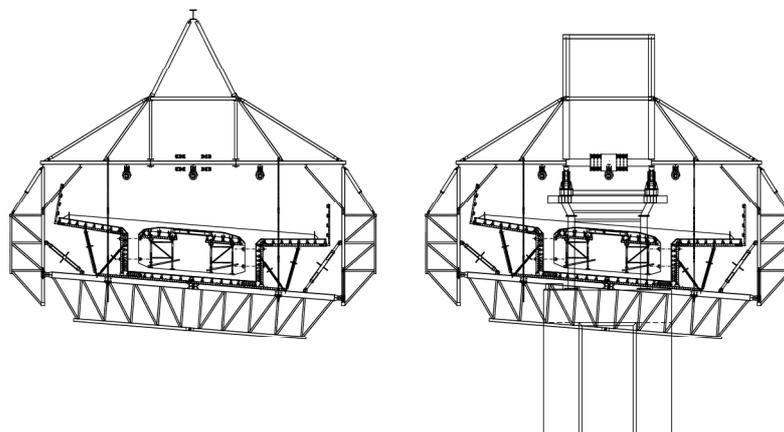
Cortes transversais do cimbra M50-S: vão (esq.) e apoio dianteiro (dir.)
